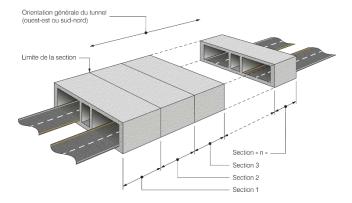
Sectionnement d'un tunnel selon l'orientation générale de la route
